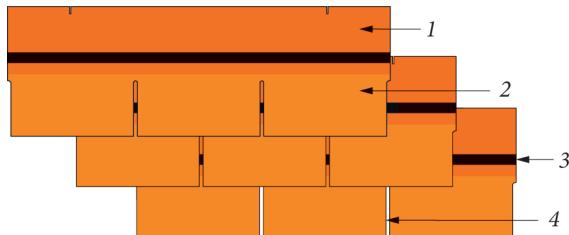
Элементы кровельного покрытия из гибкой черепицы:
